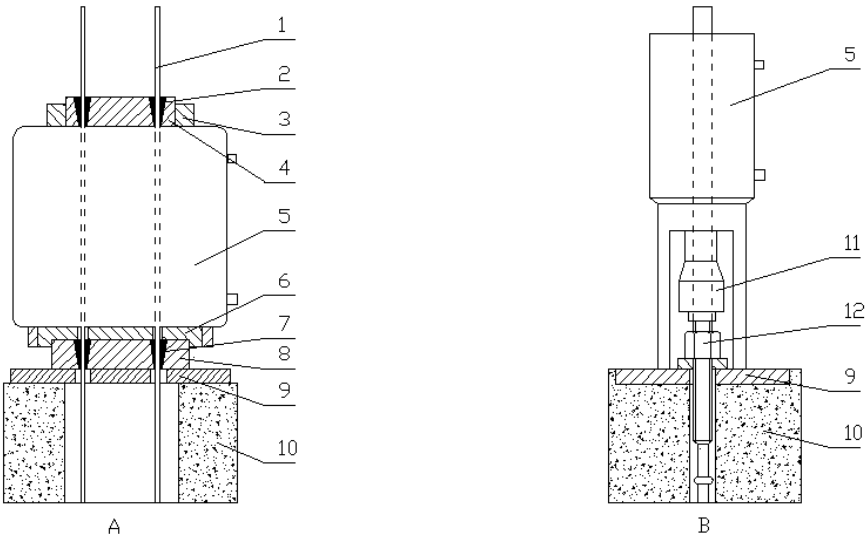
41 钢绞线及螺纹钢筋锚杆张拉示意图
